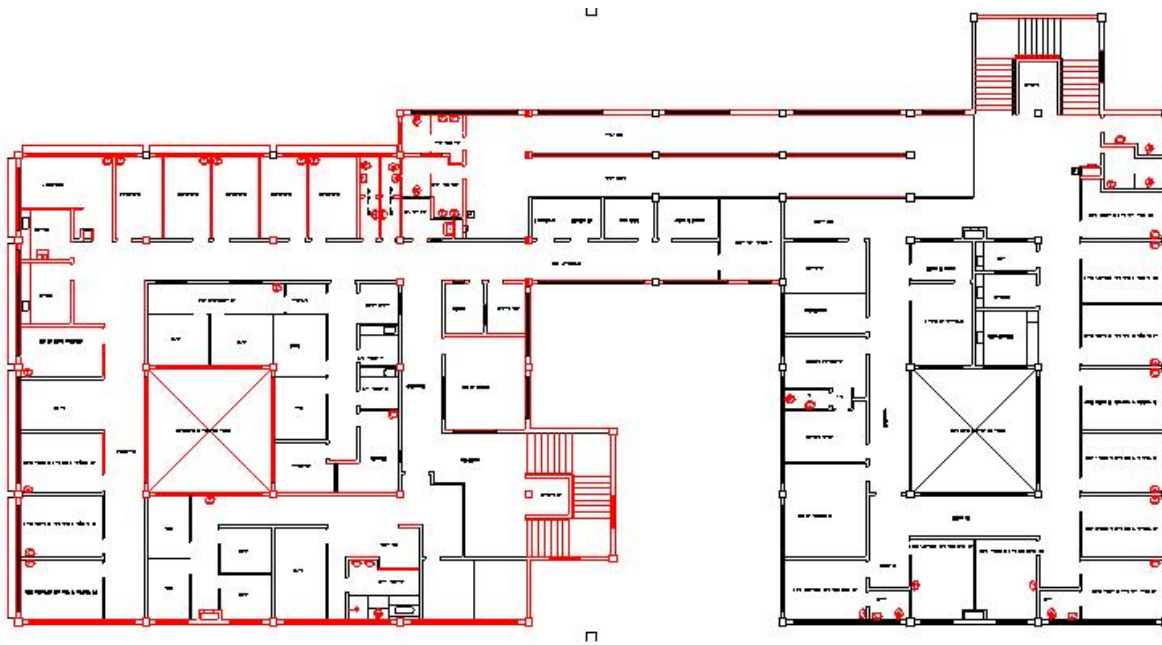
Planta baixa do pavimento tipo do atendimento ambulatorial. Fonte: Cedido pelo HUPES
